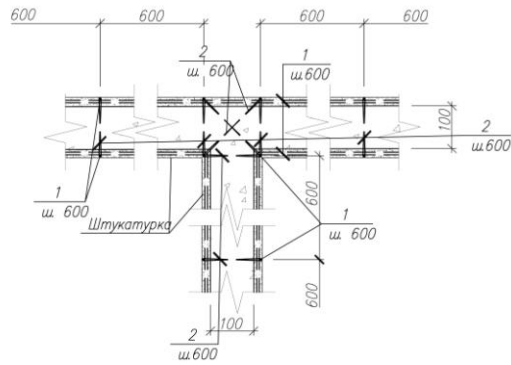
Сопряжение перегородок из керамзитобетонных блоков толщиной 100мм
